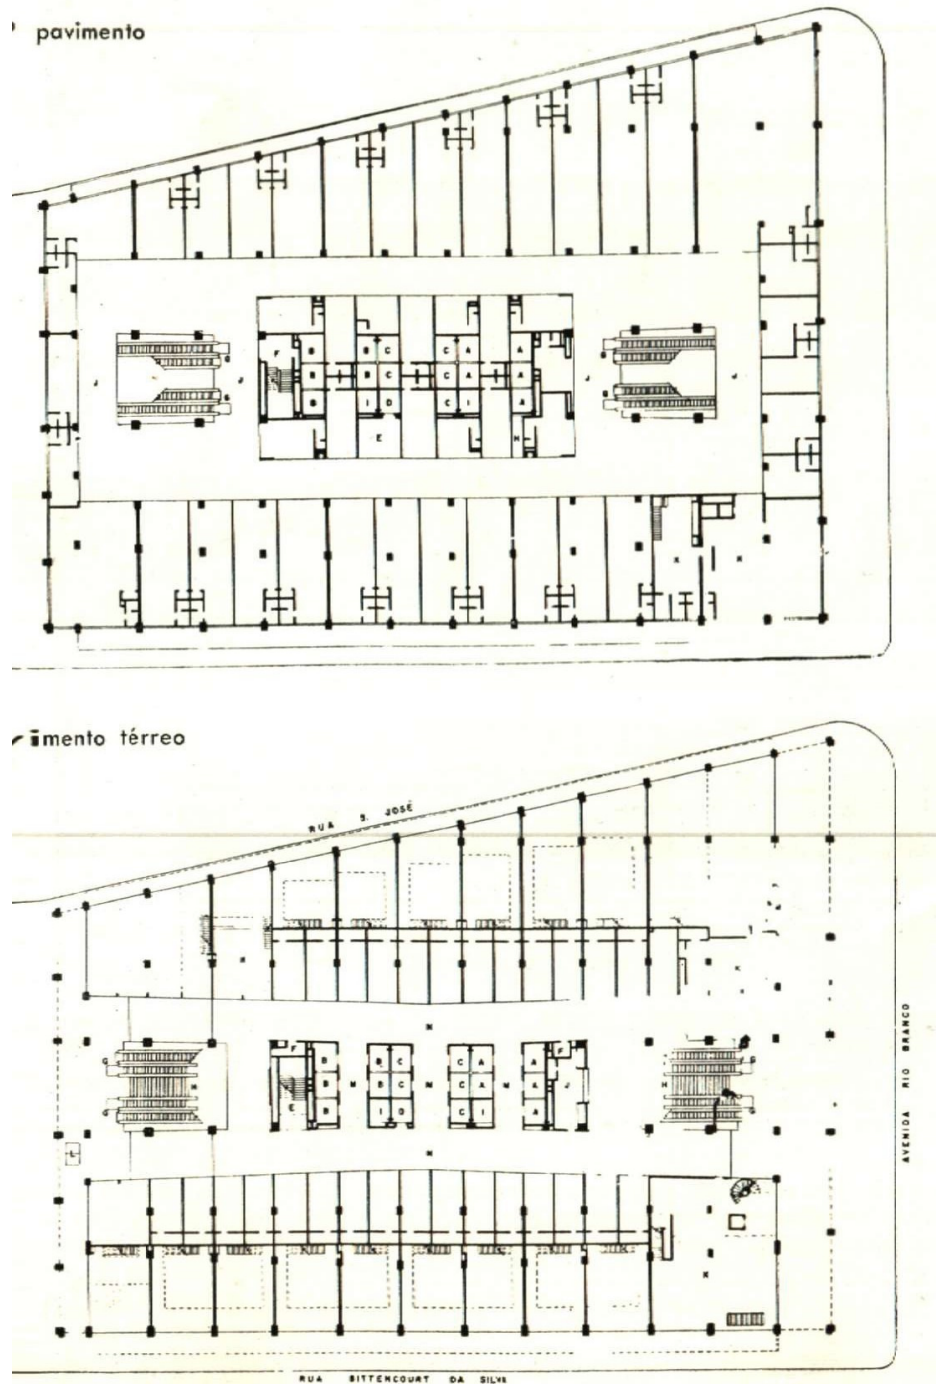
E – Plantas baixas do térreo e do primeiro piso do bloco base
